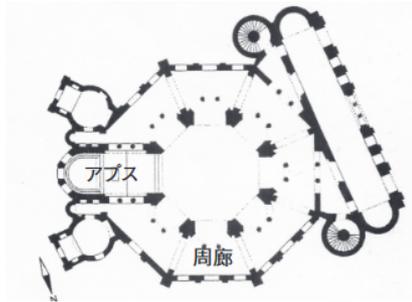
サン・ピターレ聖堂の平面図 ¹⁵⁾
